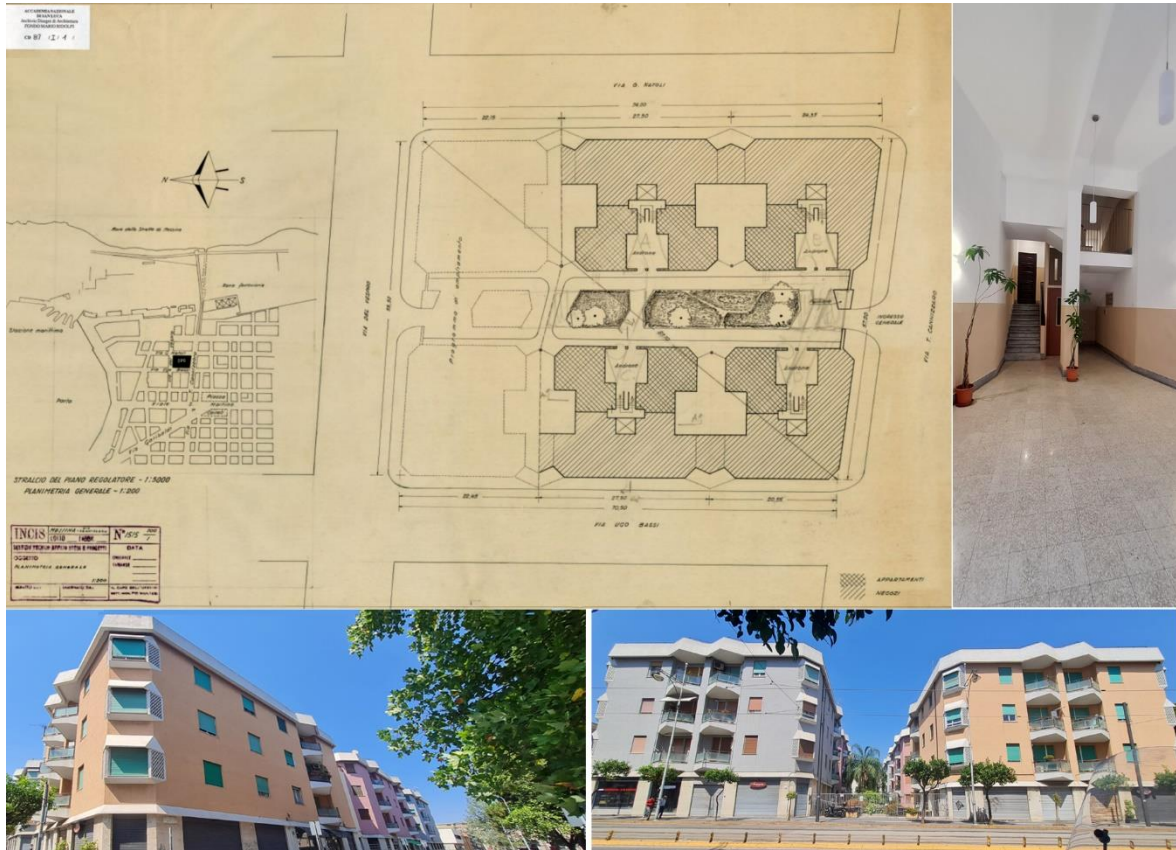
Planimetria con indicazioni "climatiche" e foto del complesso INCIS © Fondo Ridolfi-Frankl-Malagricci
